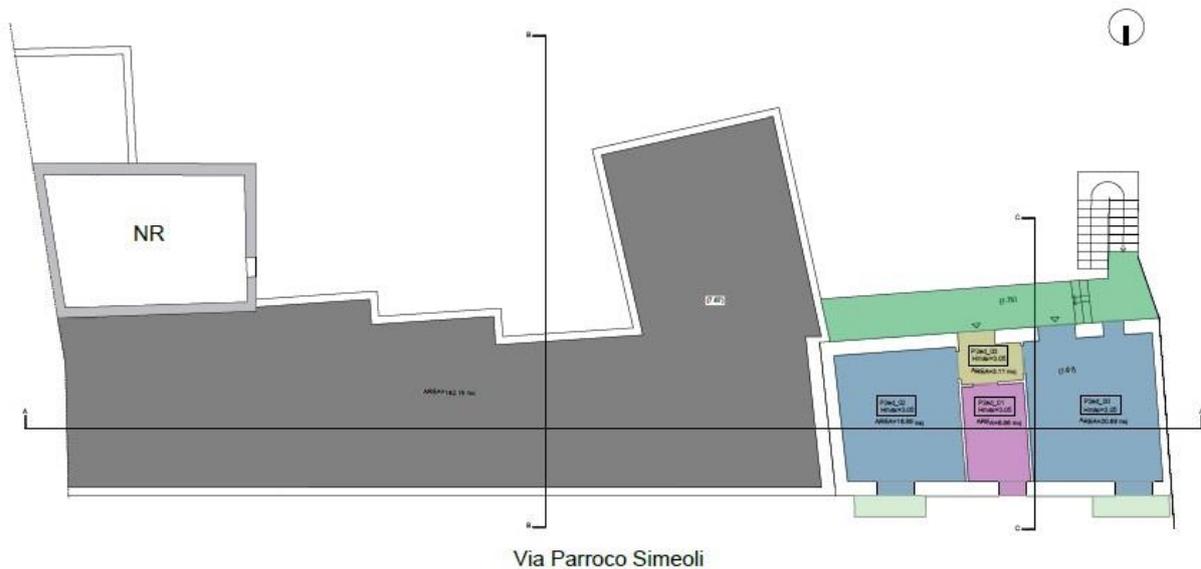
Rilievo funzionale edifici D/E (pianta piano secondo)
